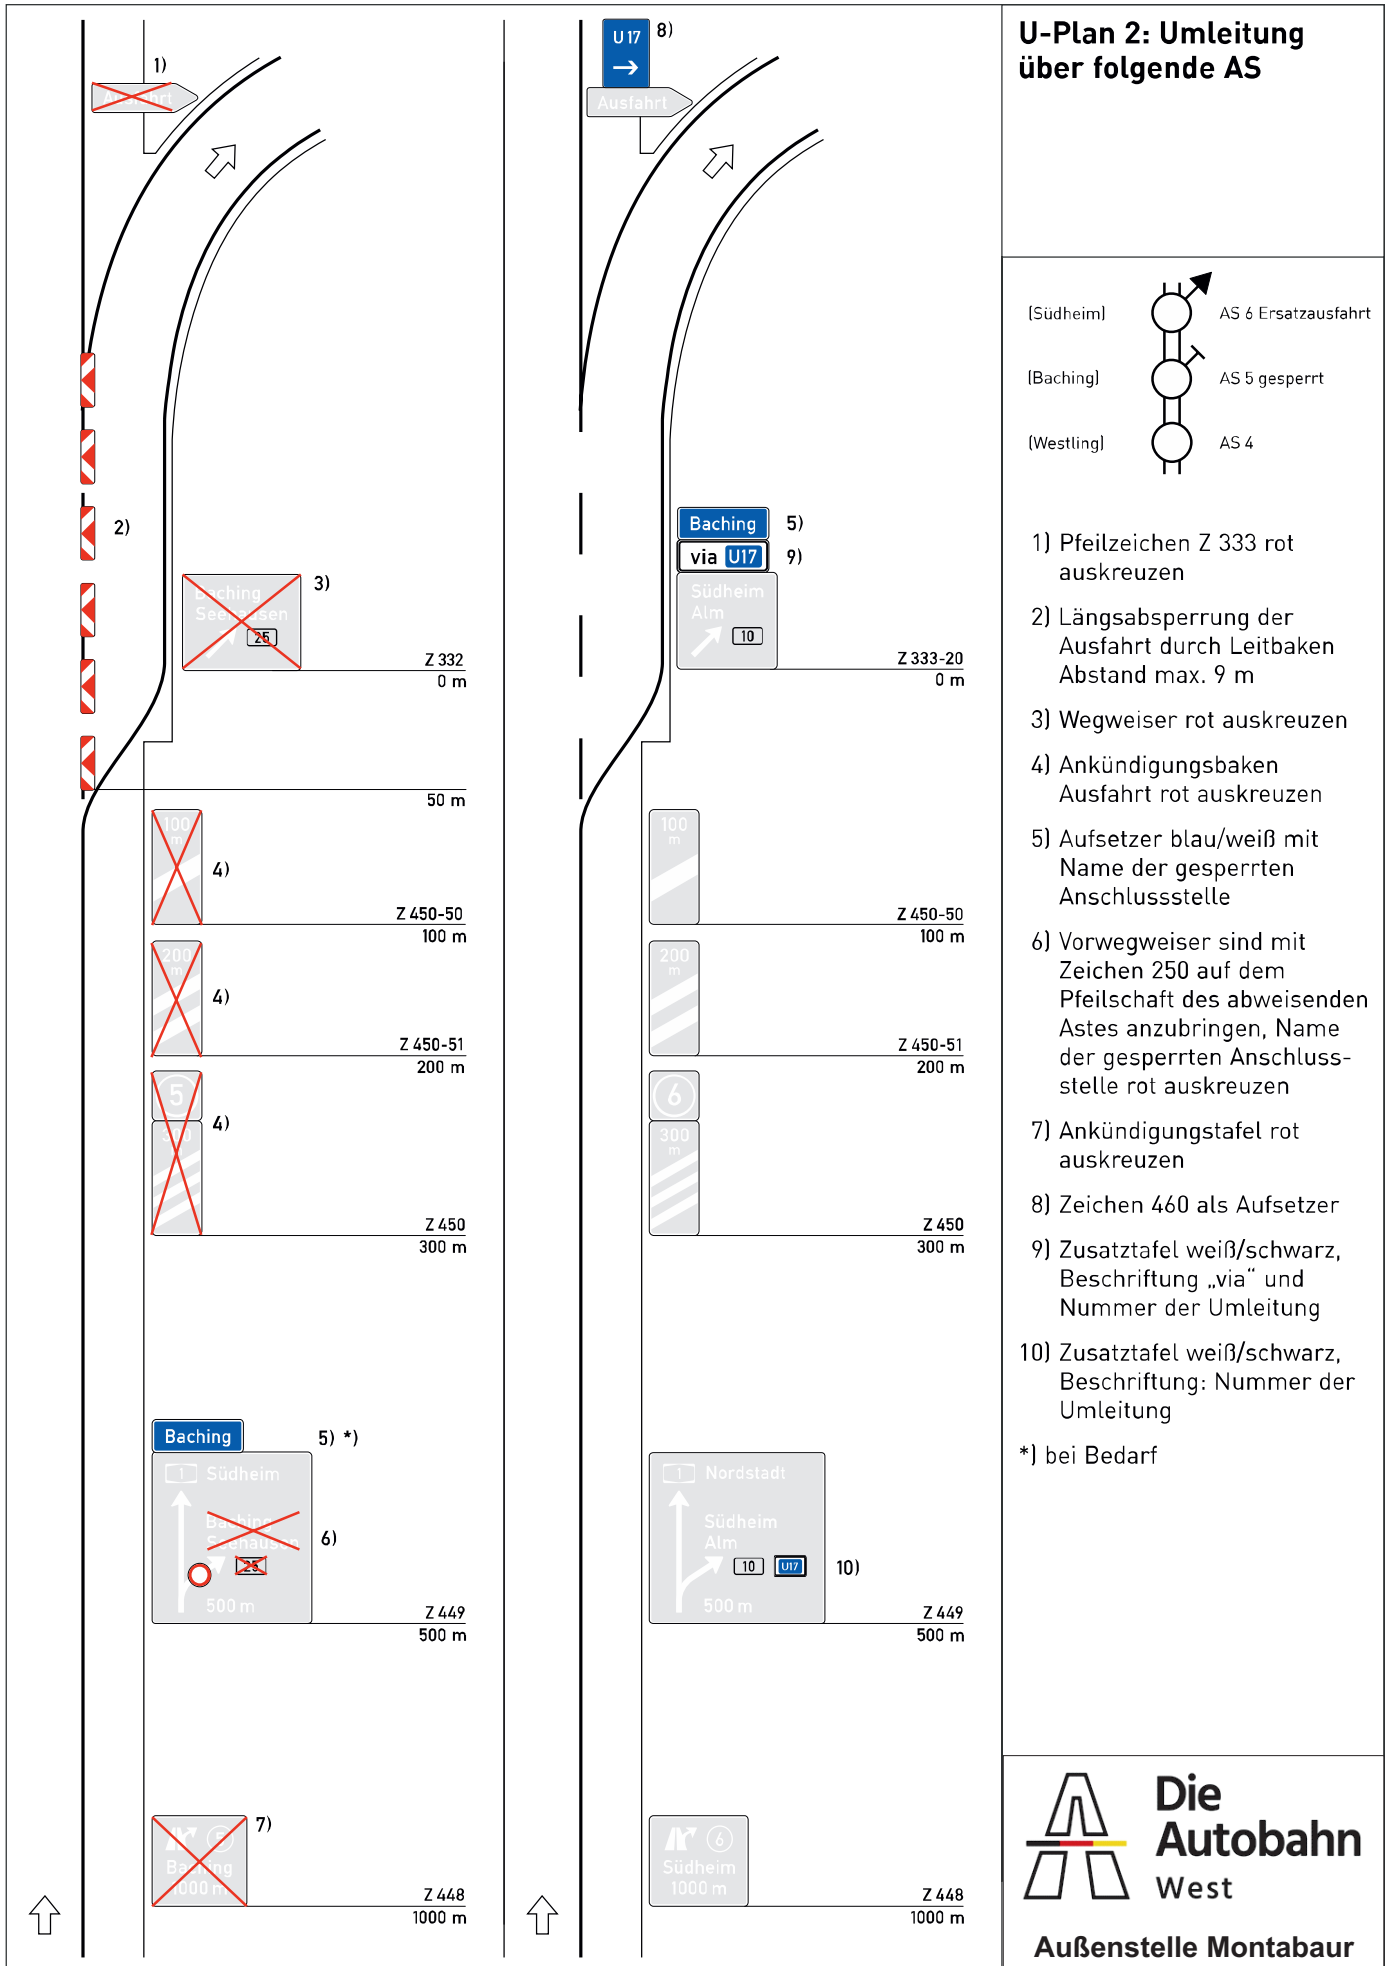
Umleitungsplan 2: Umleitung über nachfolgende Anschlussstelle
